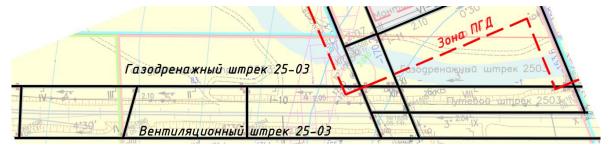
План горных работ по угольному пласту «Поленовский» в зоне расположения газодренажного штрека 25-03
